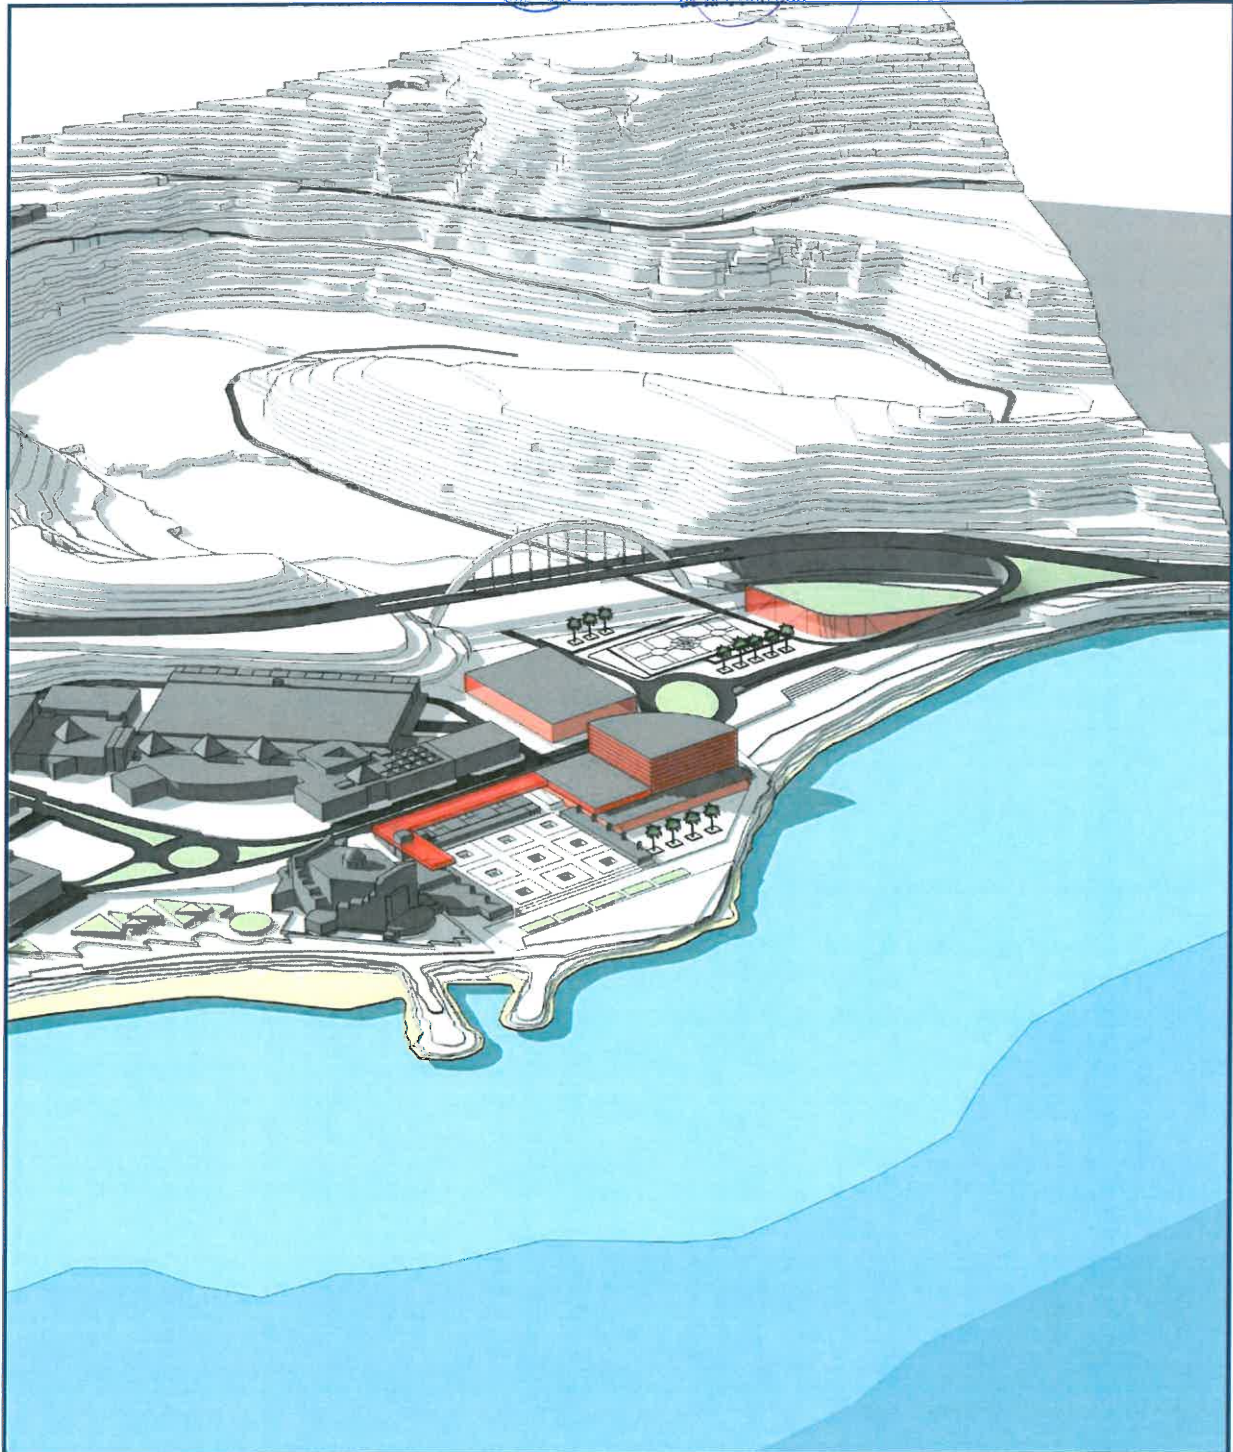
Alternativa 0. Imagen de la volumetría 1. Fuente: elaboración propia
